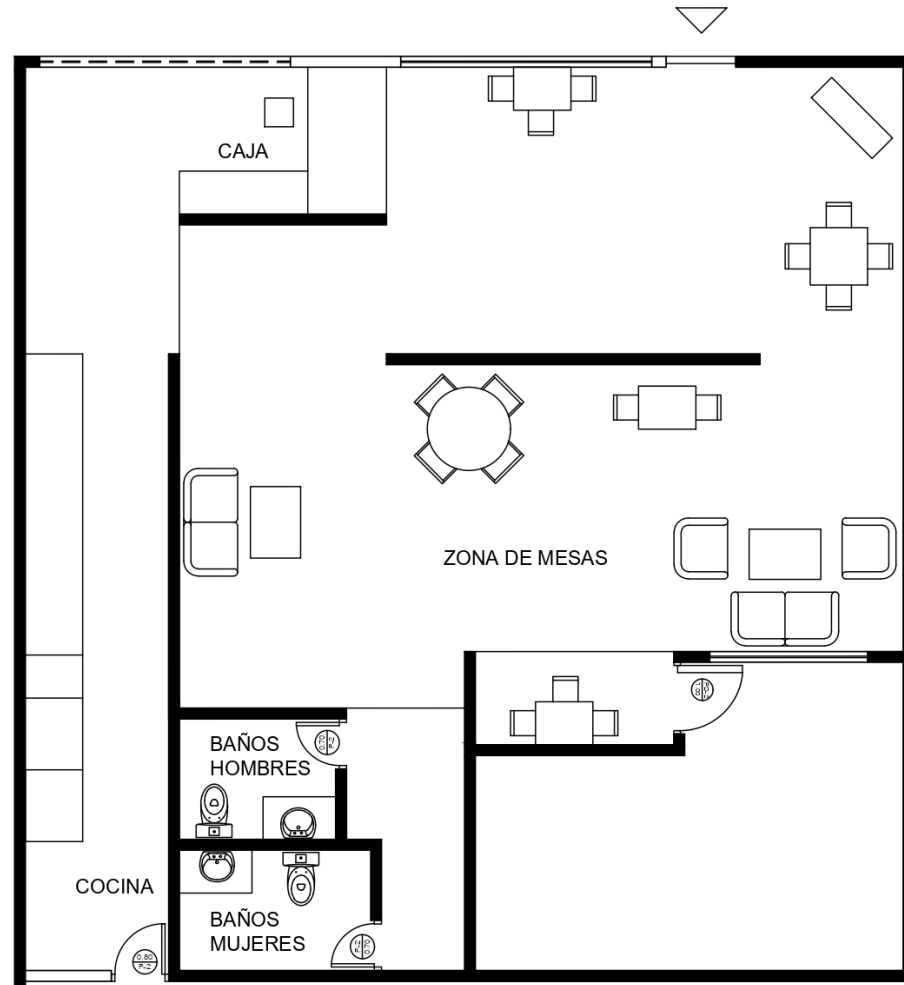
Planta baja - Estado actual. Fuente: Elaboración propia.
